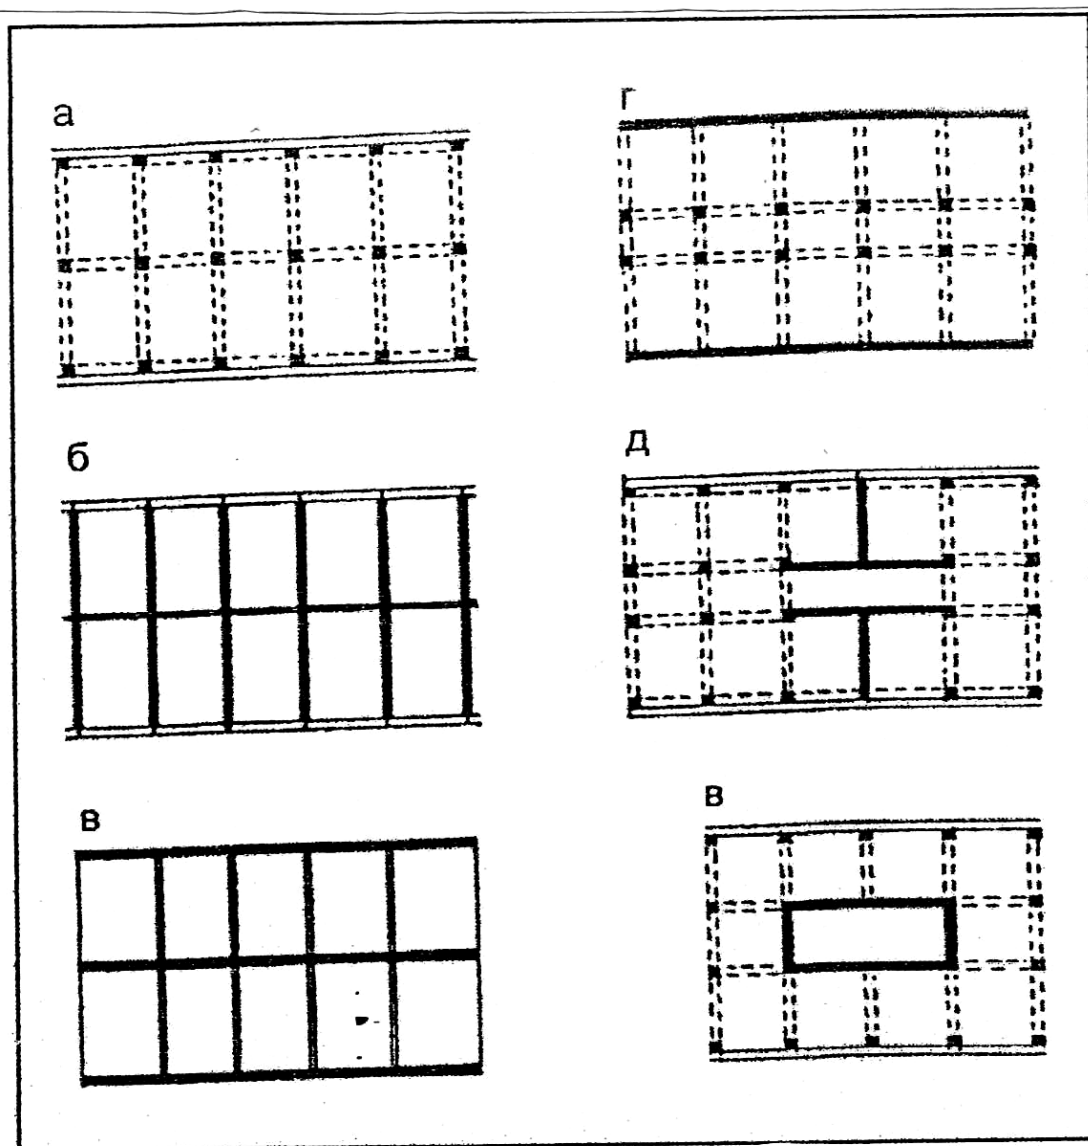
Виды несущего остова жилых домов: а – каркас; б – поперечные несущие стены; в – продольные несущие стены; г, д, е – комбинированные схемы
